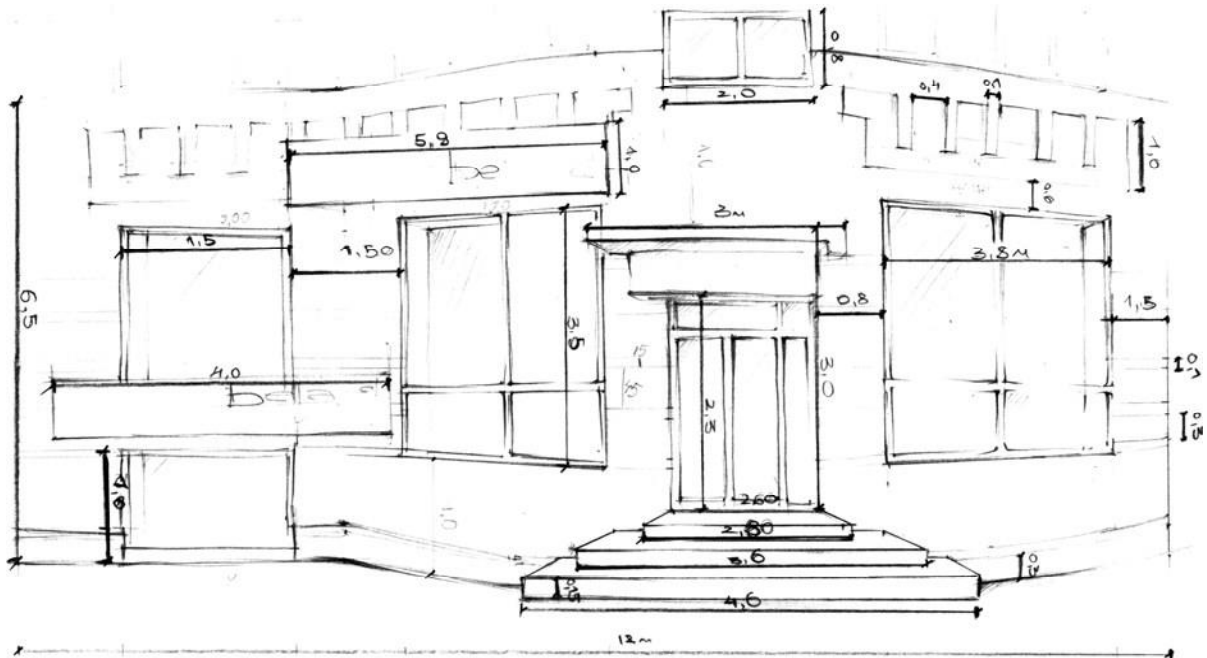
Фрагмент фасаду з входом у громадську будівлю
